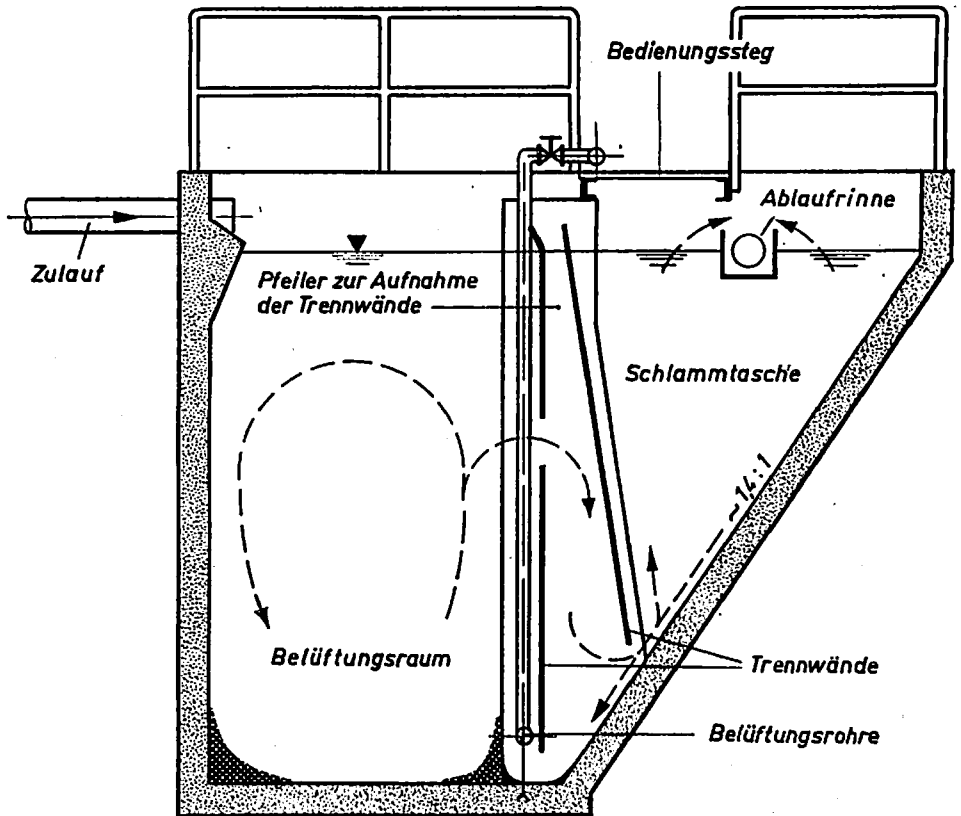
Kleinbelebungsanlage (Typ Totalkläranlage)
